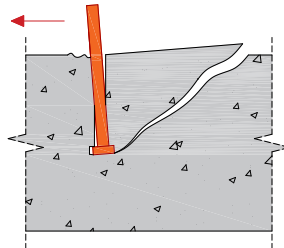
Rotura da ancoragem ao corte - 3º modo: *pry-out* por levantamento do betão.
